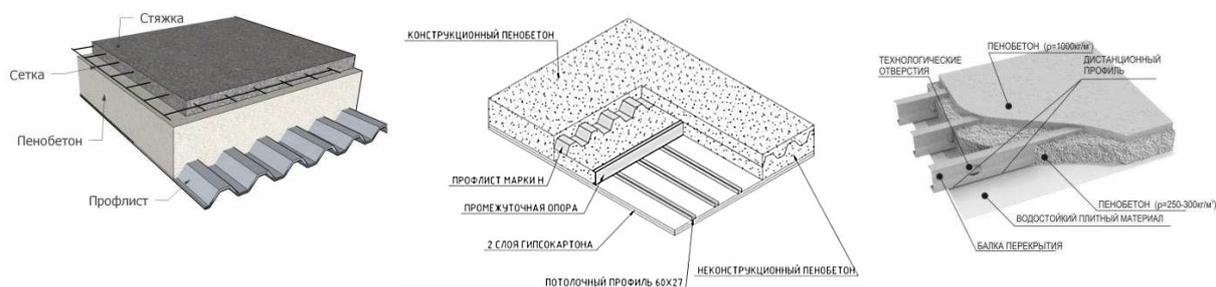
Варианты плитных конструкций с совместным использованием ЛСТК и пенобетона [3; 4]
